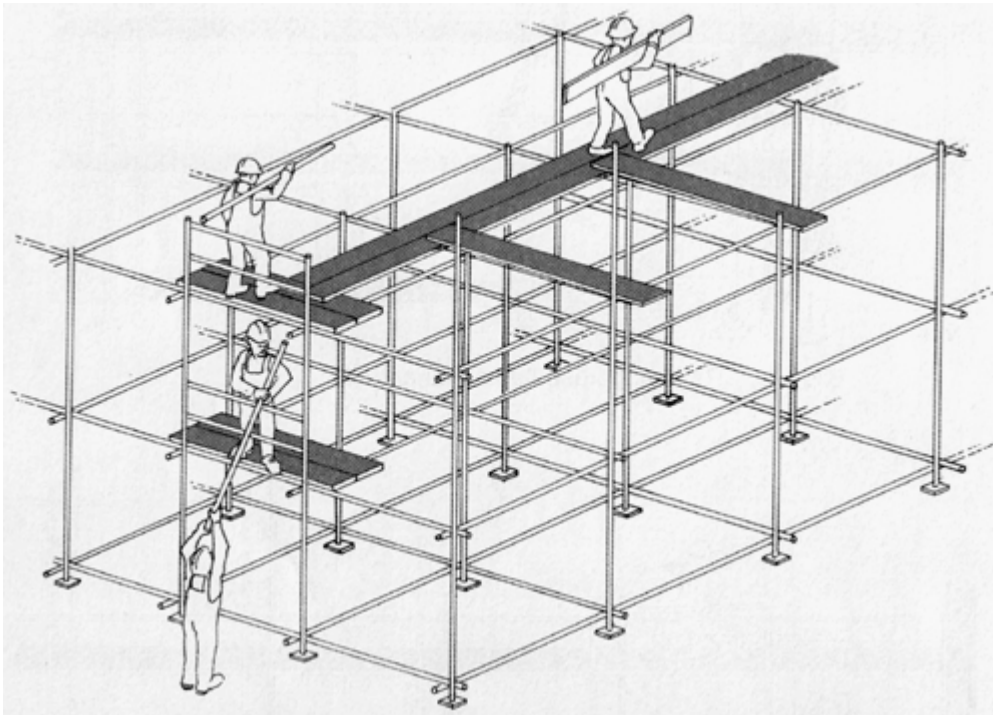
Erforderliche Gerüstlagen zum Aufbau von Raumgerüsten
